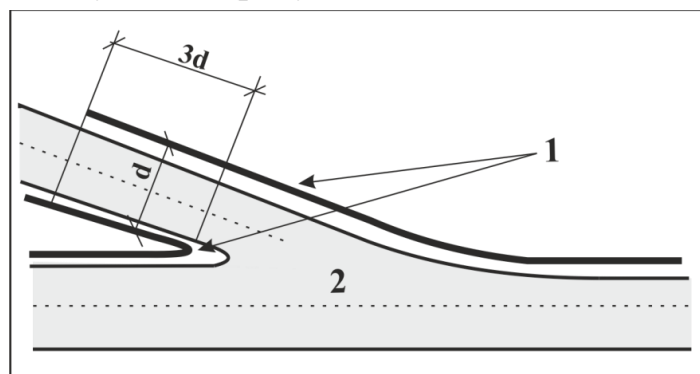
Схемы устройства экранов на участках разрыва и перекрытия
